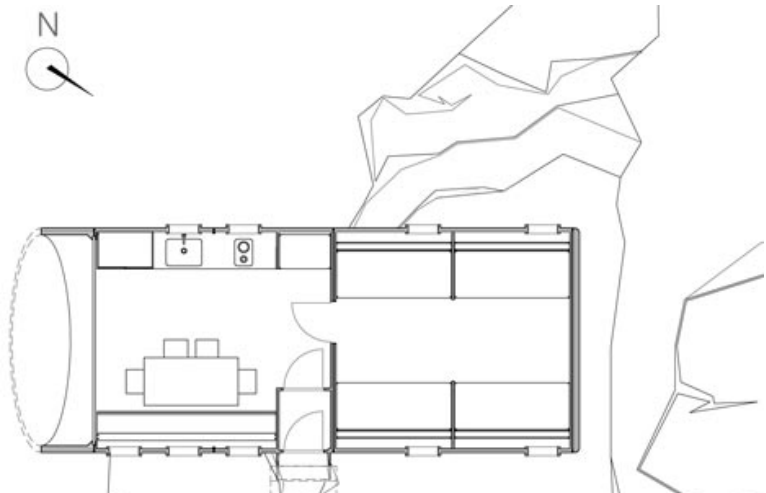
36 Grundriss, Aufenthaltsraum und Schlafplätze
